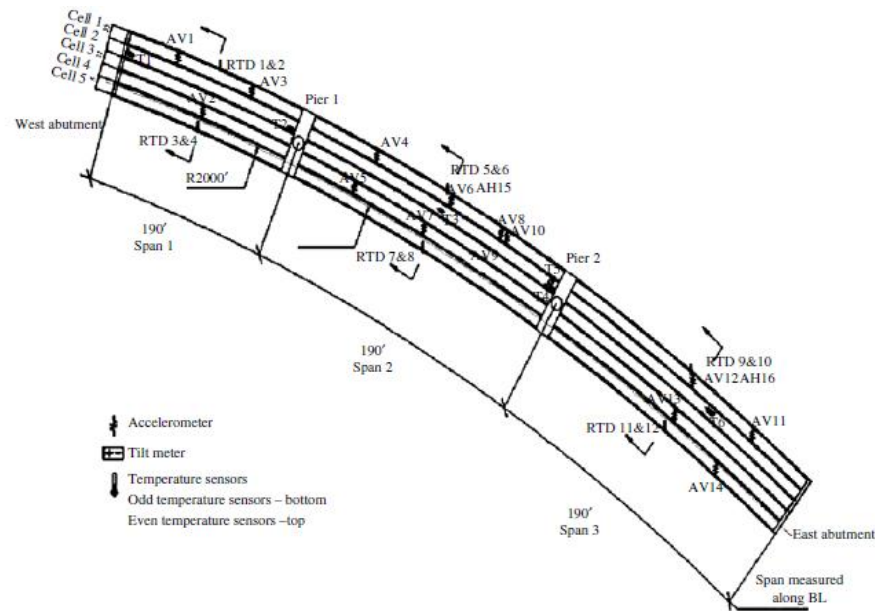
Vista en planta del puente Connecticut con los sistemas de instrumentación para el monitoreo. Adaptado de elsevier.com (Development of a baseline for structural health monitoring for a curved post-tensioned concrete box girder bridge. p. 3)
